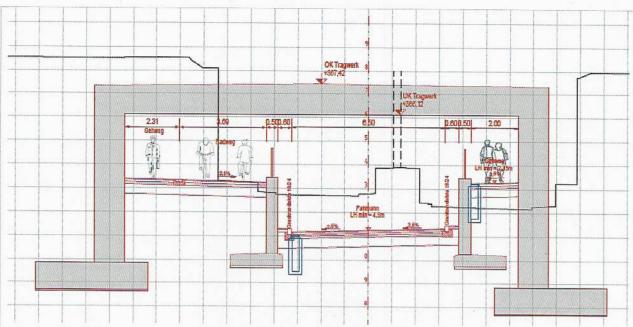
Peter Tunner Gasse - Unterführungsquerschnitt (Blickrichtung nach Westen)
